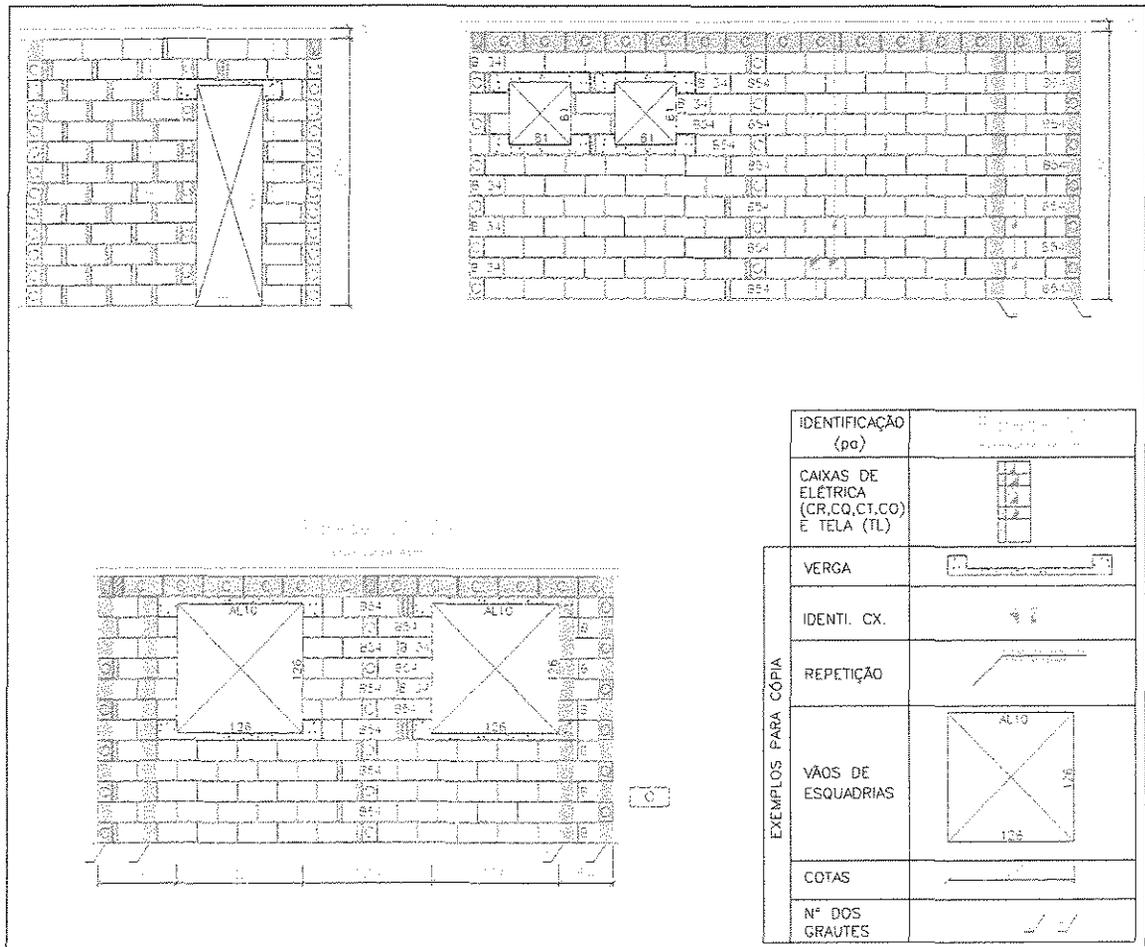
Elevações das Alvenarias do Pavimento Tipo
